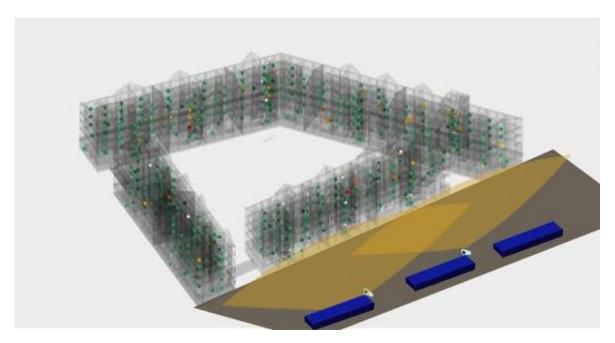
Расположение смарт-видеокамер для исследования участка строительной площадки ЖК «Пулковский дом»
